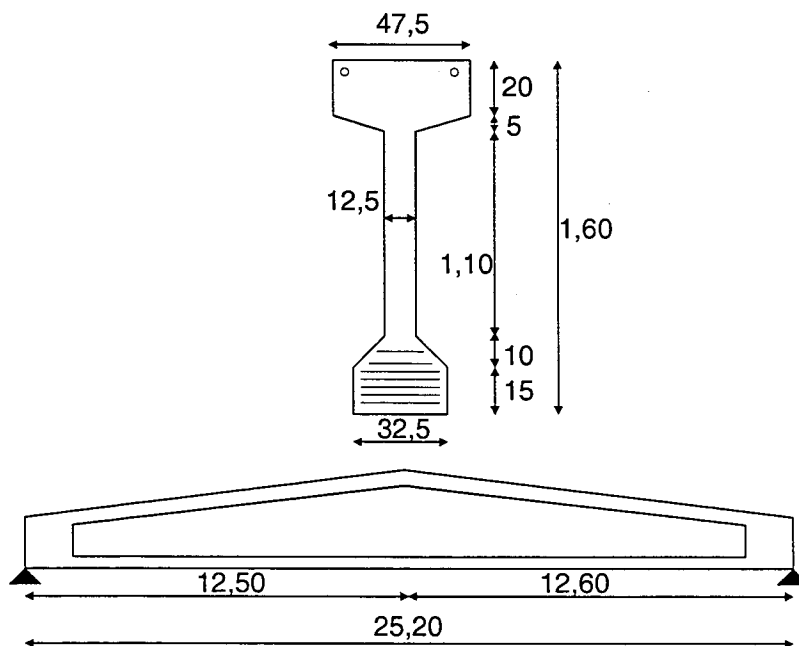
Quer- und Längsschnitt des Spannbetonbalken
